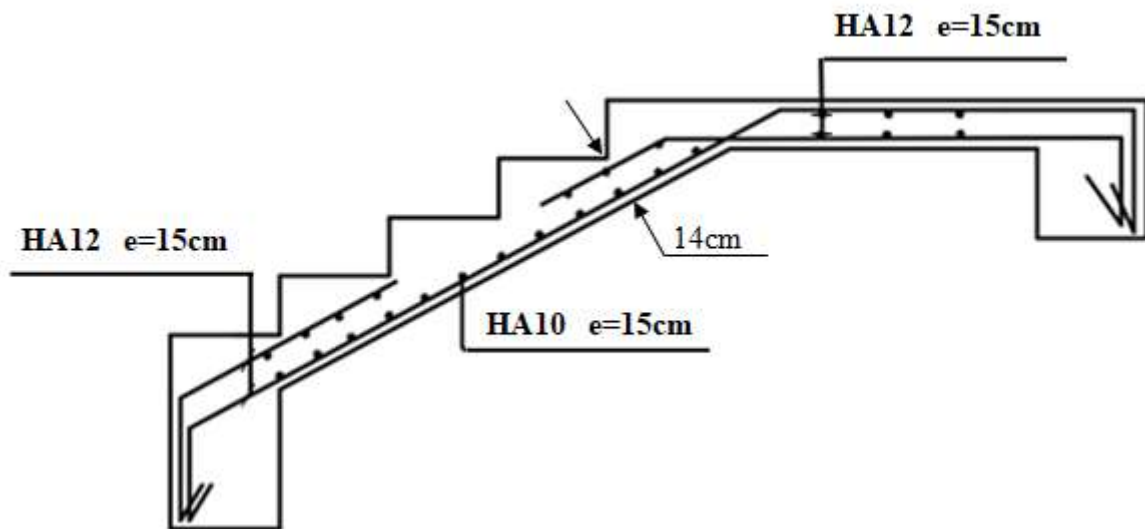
Schéma de ferrailage de l'escalier (type 1).
